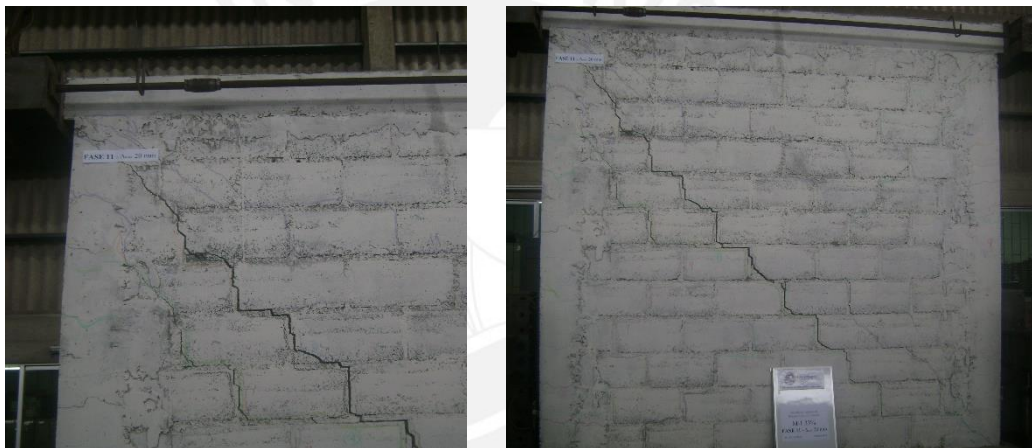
Fase 11: Grietas en zona superior de las columnas se intensifican.
